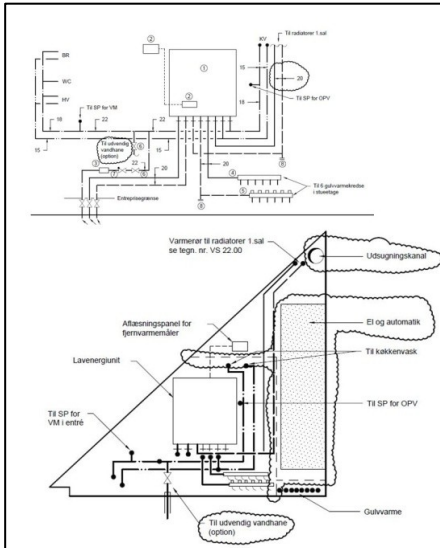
, Technical drawing, courtesy of mechanical engineer, case 1
